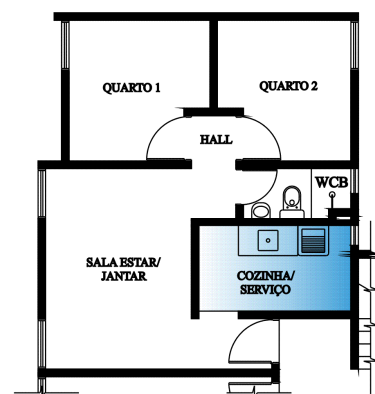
Planta Baixa Pav. Tipo do Residencial Luiz dos Anjos (sem escala)
